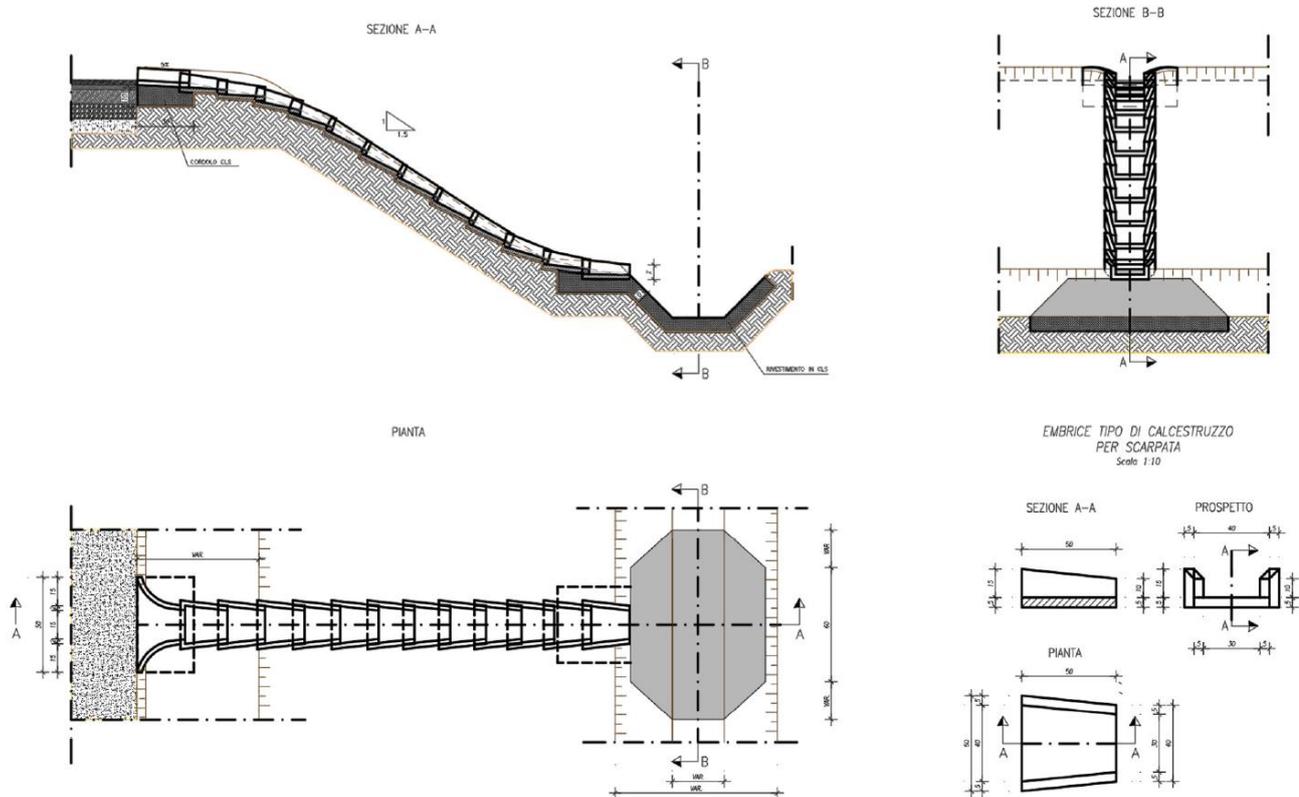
Dettaglio degli embrici in pianta e in sezione
